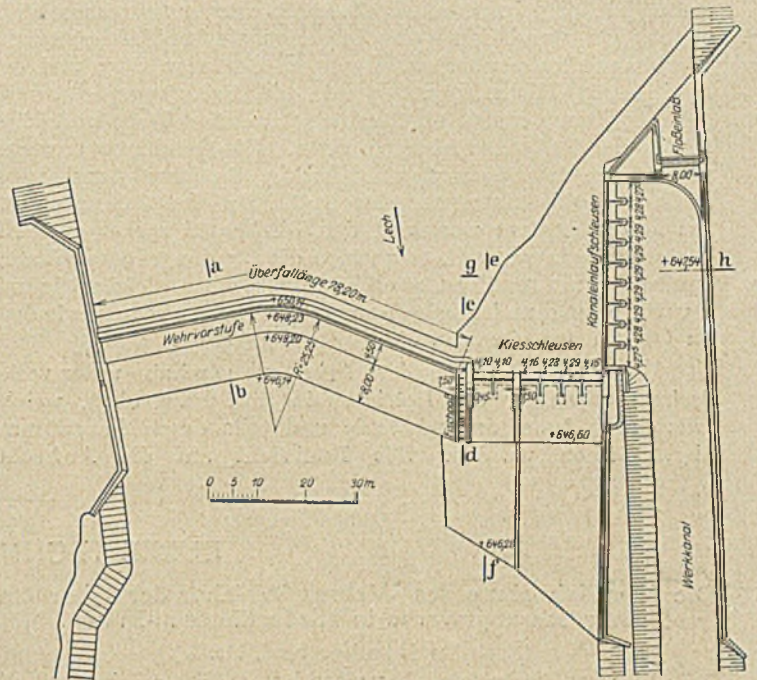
Grundriß der Wehranlage nach dem Umbau.
